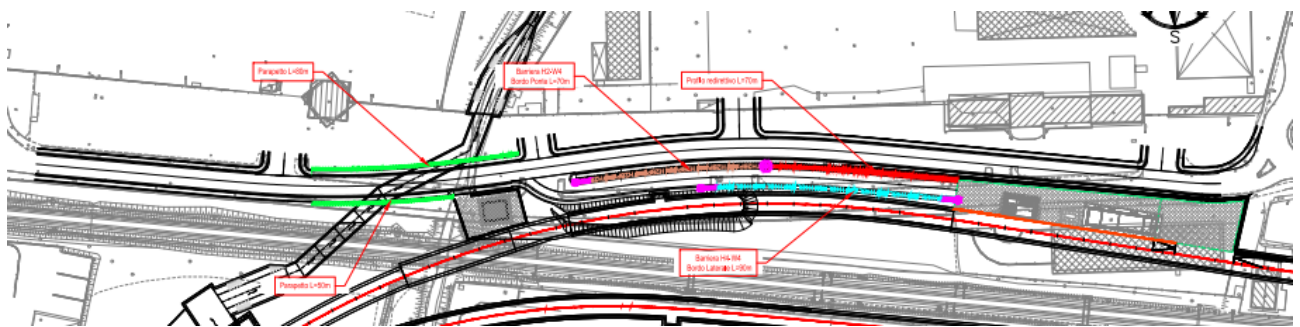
Stralcio planimetrico della tipologia di barriere lungo il tracciato della viabilità NV02.1
